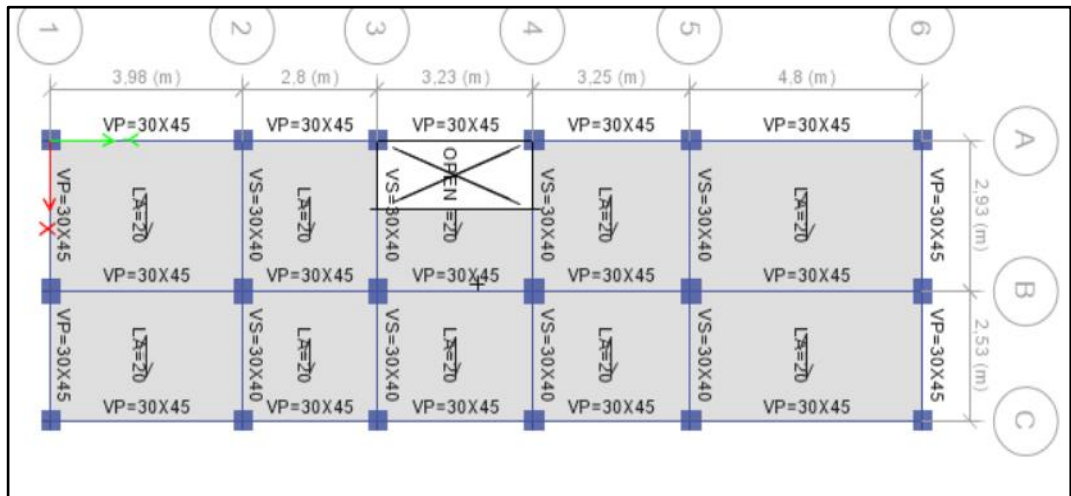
Plano con los Elementos Estructurales del Edificio B (Etabs)
